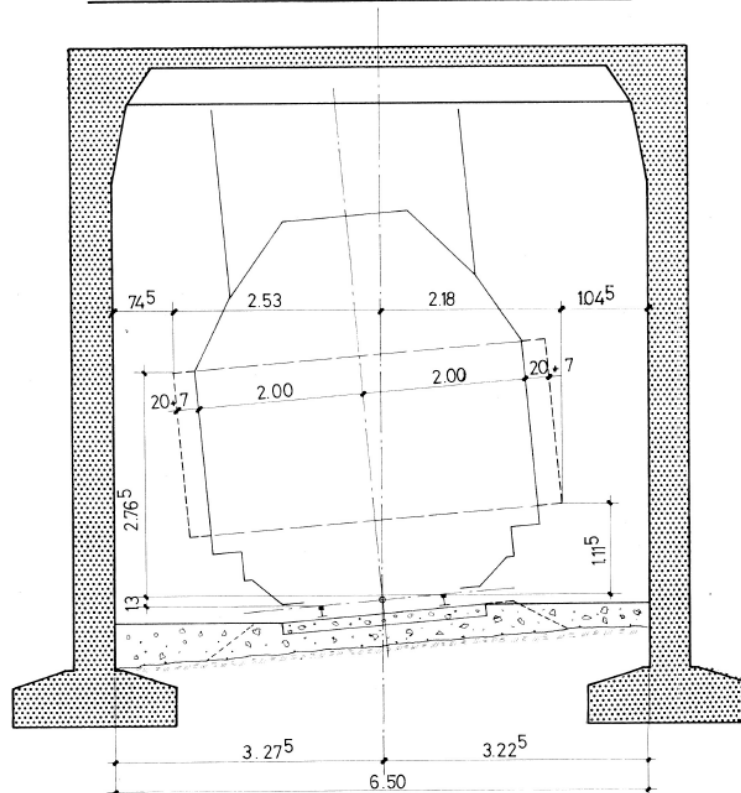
Normalprofil Tunnelverlängerung [5]
